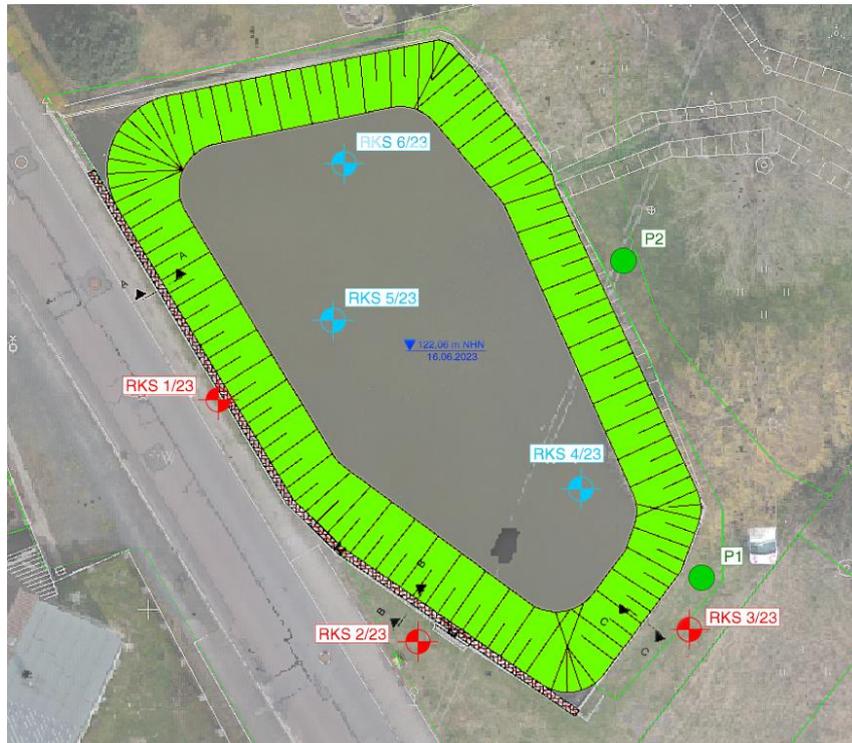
Übersicht der Lage der Baugrundaufschlüsse [3]
